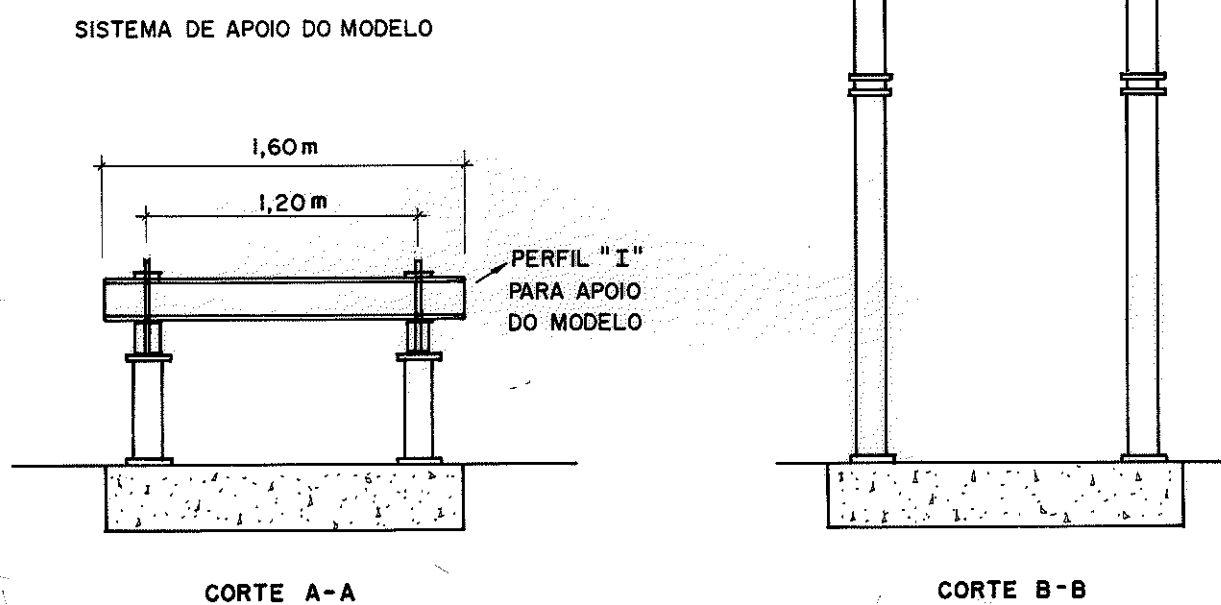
B- Sistema de apoio, pórtico e laje de reação
